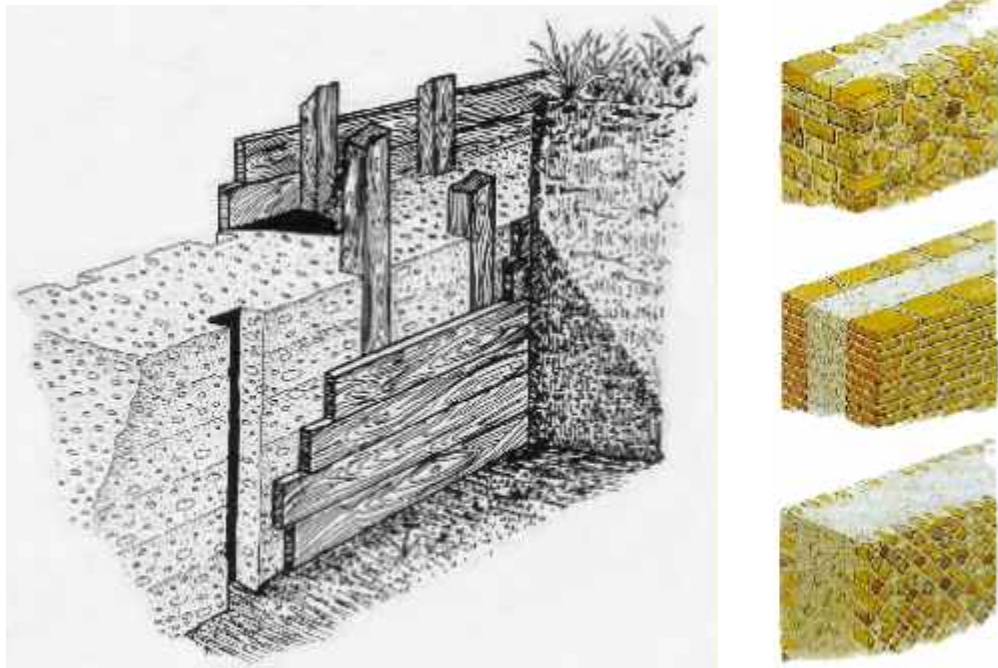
Cimbra para el colado de un muro con hormigón de cal (Marinucci, 1988)
